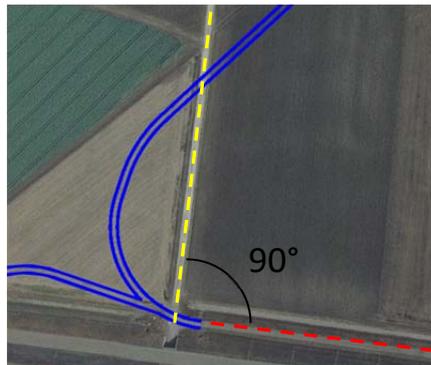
Stralcio vista raccordo di accesso alle turbine MN12 e MN05
